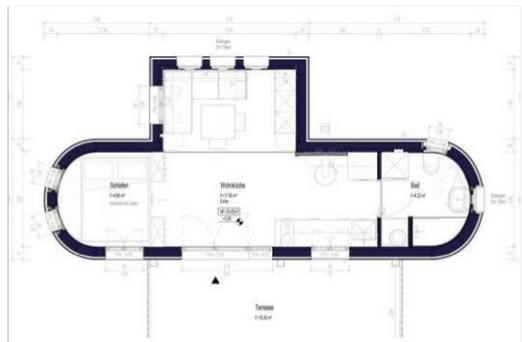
Grundriss Wohnwagen Modell Fanni
